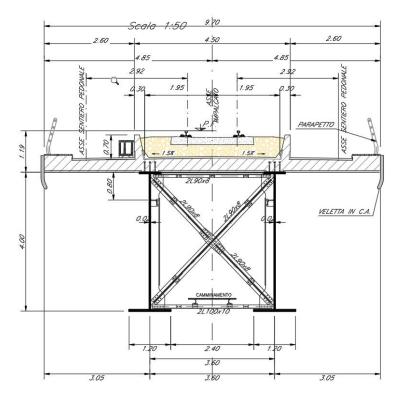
sezione trasversale impalcato tipo in acciaio 50m singolo binario
